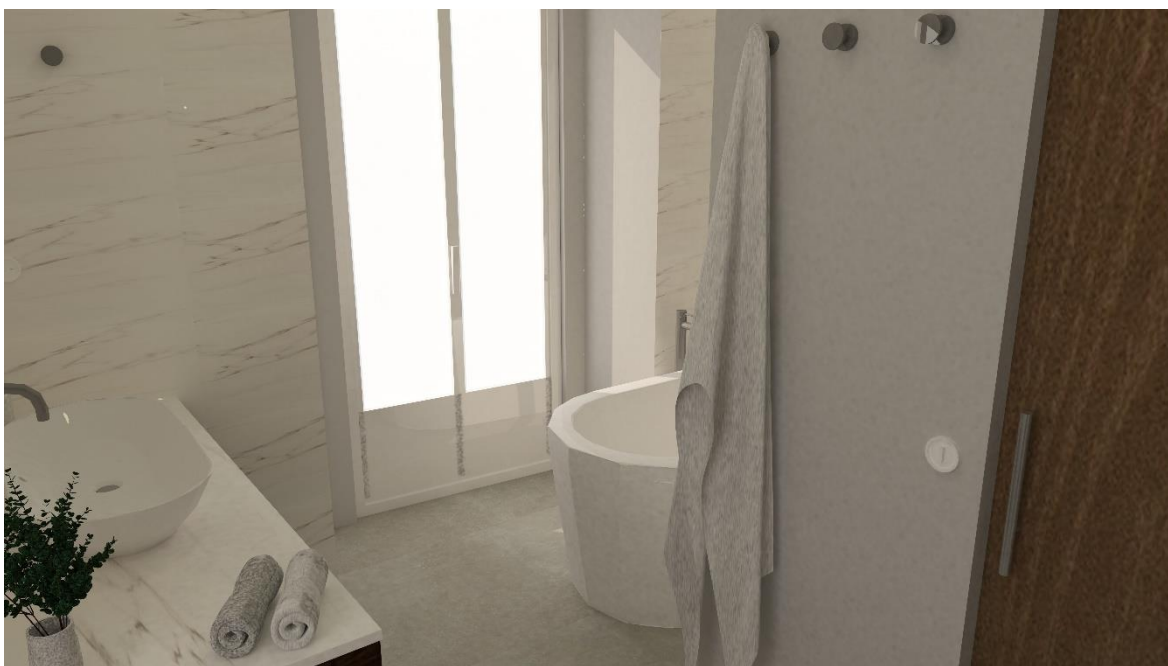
Visualização 3D - instalação sanitária, suite (vista 3)
